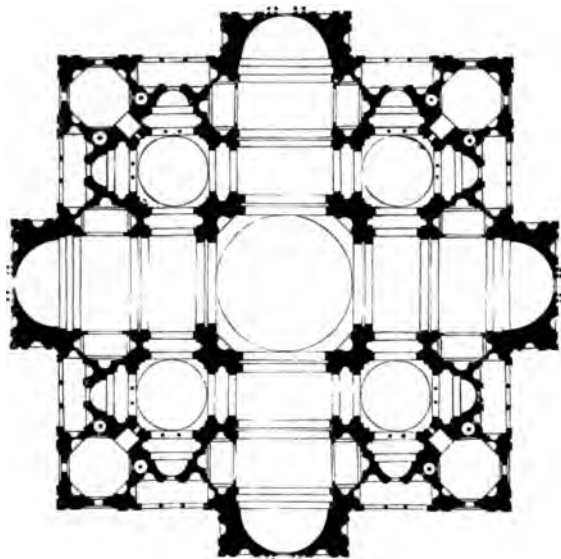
St. Peter. Bramantes erster Grundriss.
